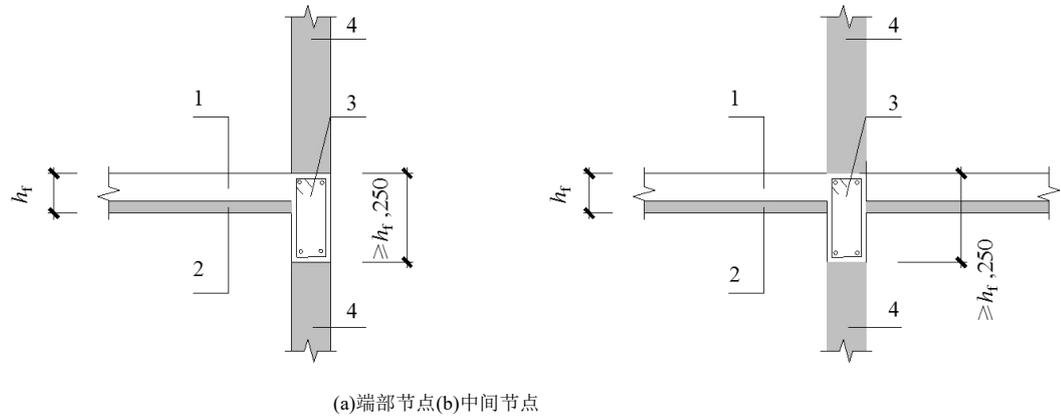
后浇钢筋混凝土圈梁构造示意
